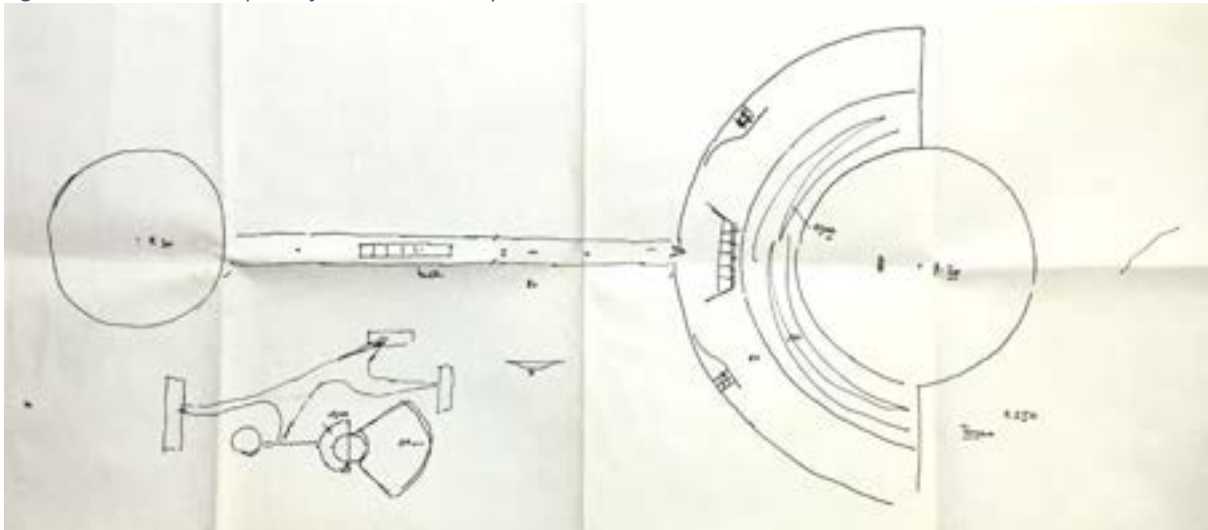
Planta e implantação – Oscar Niemeyer. – Fonte: Acervo Gilberto Antunes
